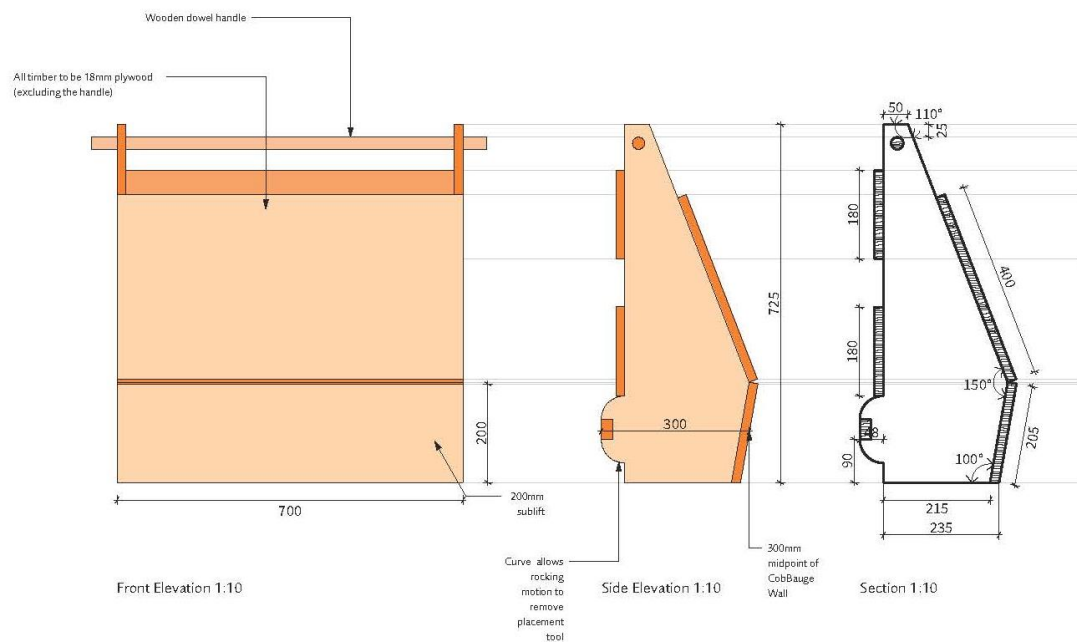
Dimensions d'un outil de pose CobBauge. Source : Hudson Architects (2022).
